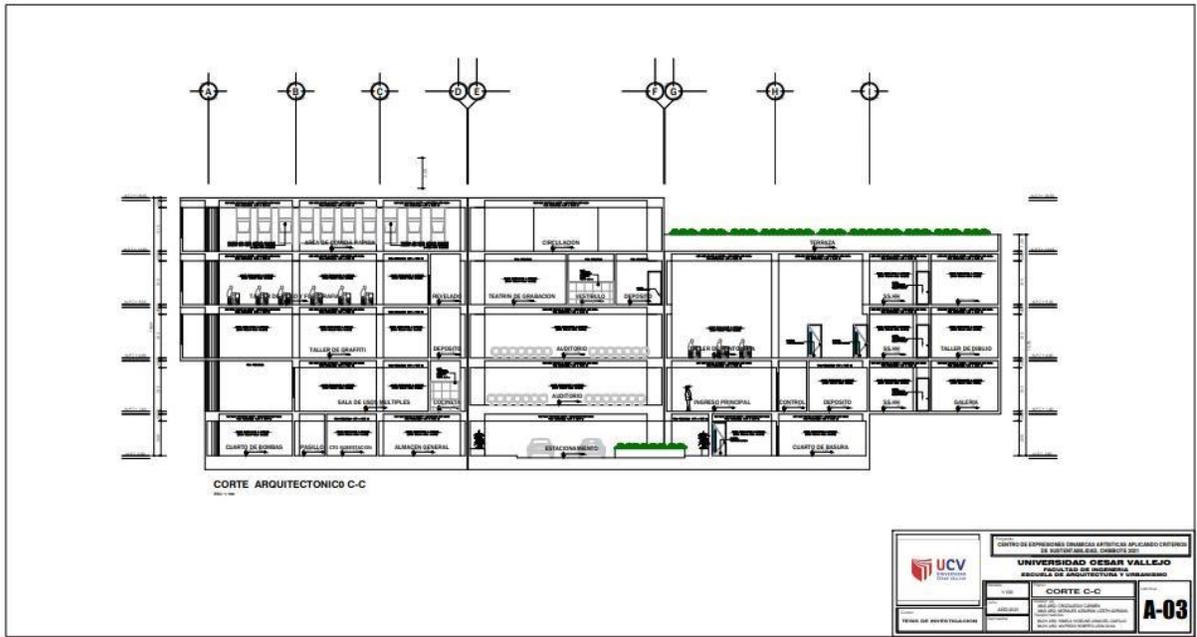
Plano Corte C-C Fuente: Elaboración Propia
